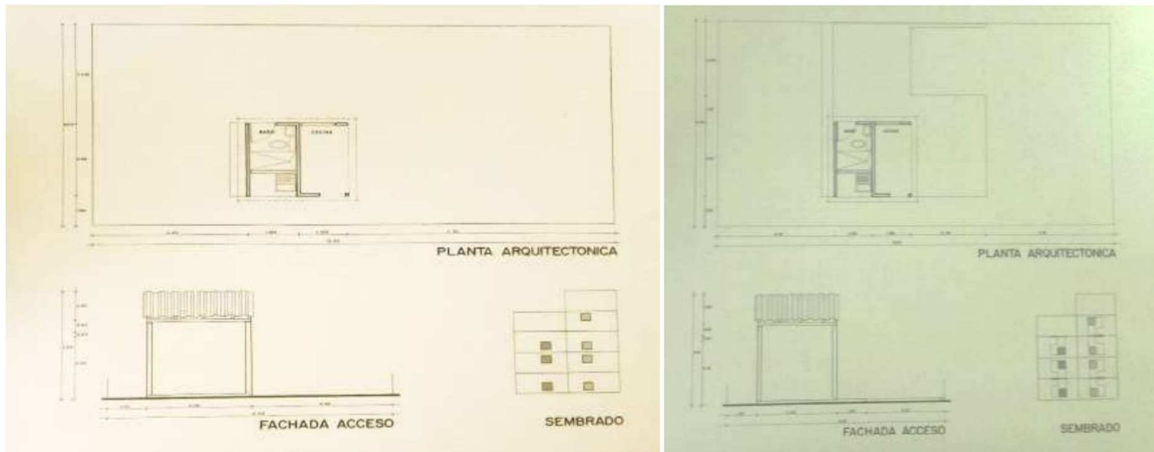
y 17. Primer (izquierda) y Segundo (derecha) Prototipo de Vivienda Directa; consisten en una unidad básica de una sola planta, un suelo en plataforma elevada que se expande en la siguiente etapa, se muestra la cubierta inclinada; planta y alzado en fachada. Obtenida de "Construcción y evolución urbana de la colonia Ciudad Renacimiento de Acapulco, Guerrero" por Miguel Ángel Sánchez Huerta, 2018, PP.: 92-93.
